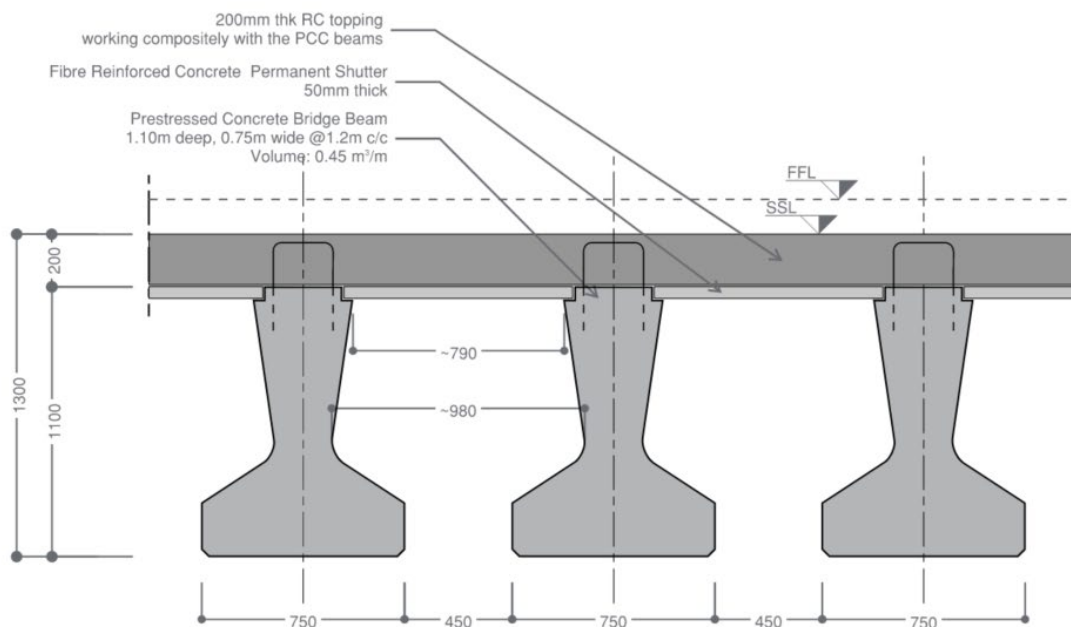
Travi da ponte prefabbricate - Sezione tipica
